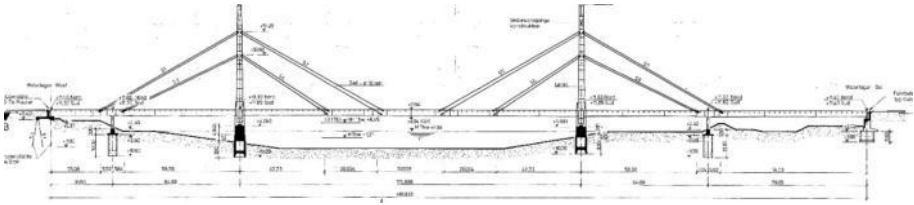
Brückenansicht mit Seilführung nach dem Umbau 1984ff
